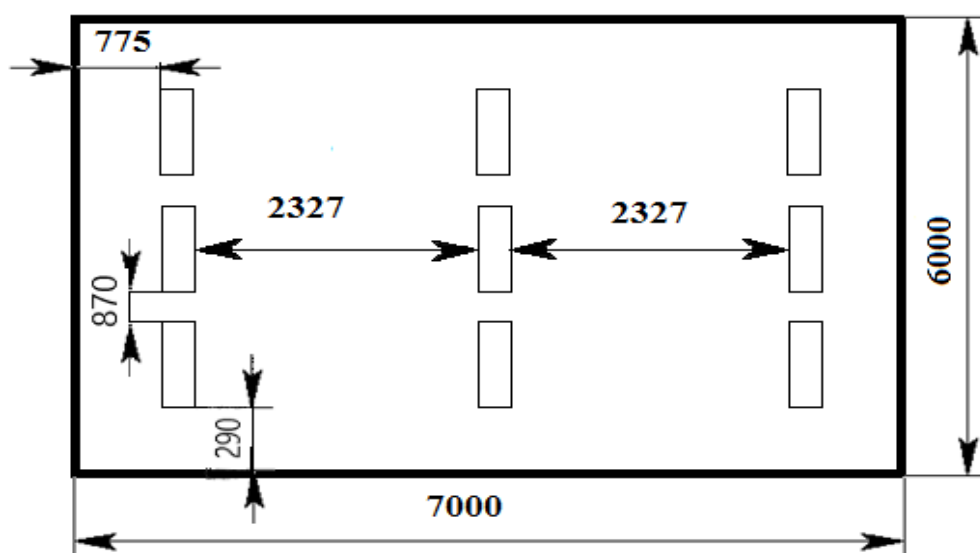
План помещения и размещения светильников с люминесцентными лампами
